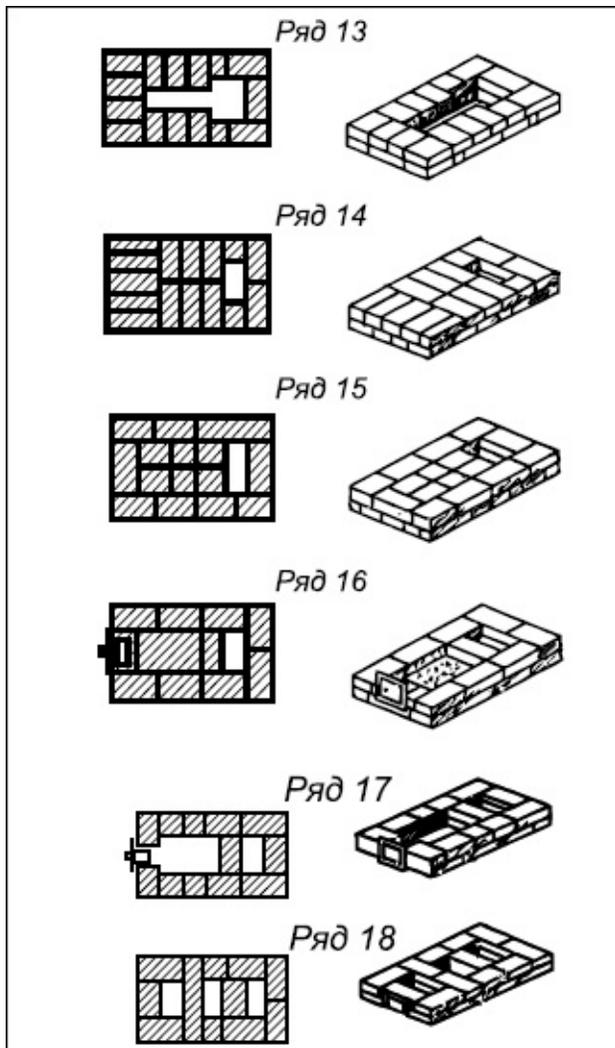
(продолжение). Кладка отопительной прямоугольной печи
